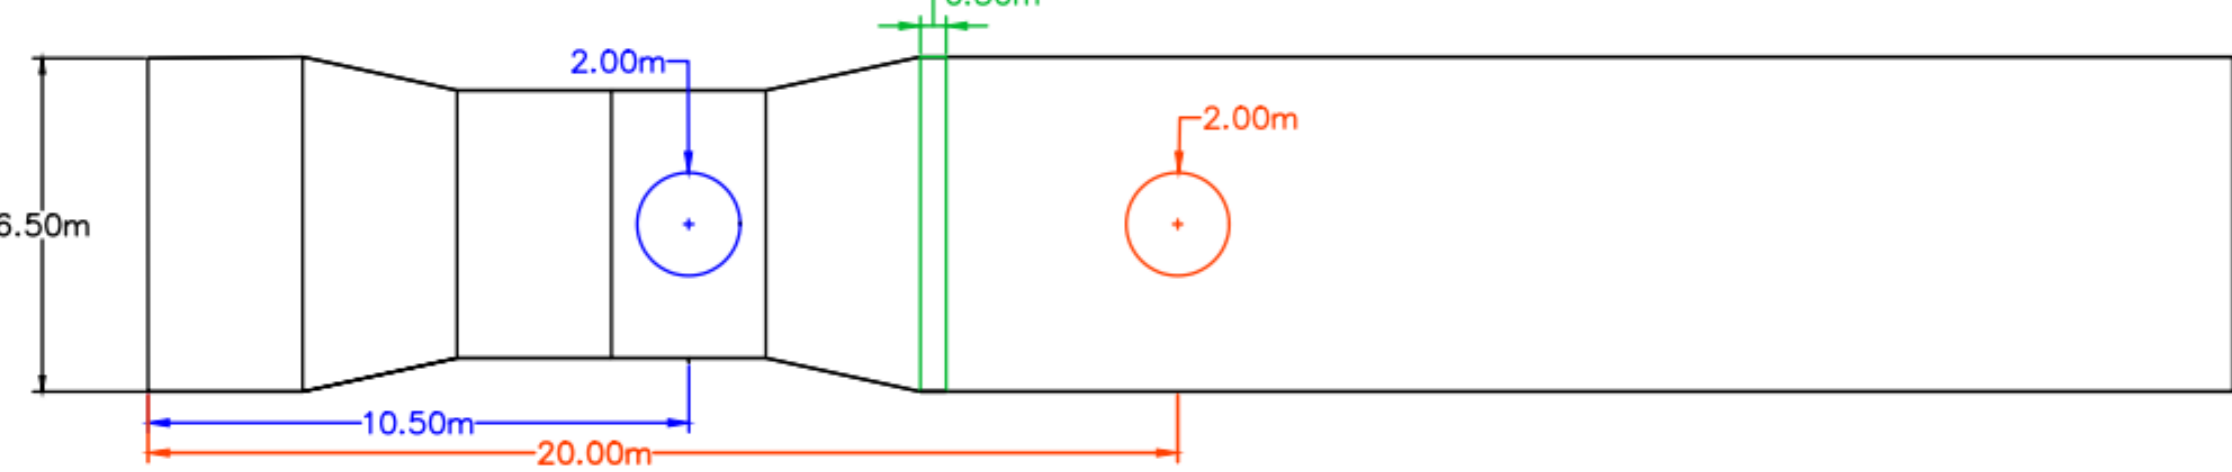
Planteamiento de estructuras. ■ Pila 1. ■ Pila 2. ■ Compuerta.
